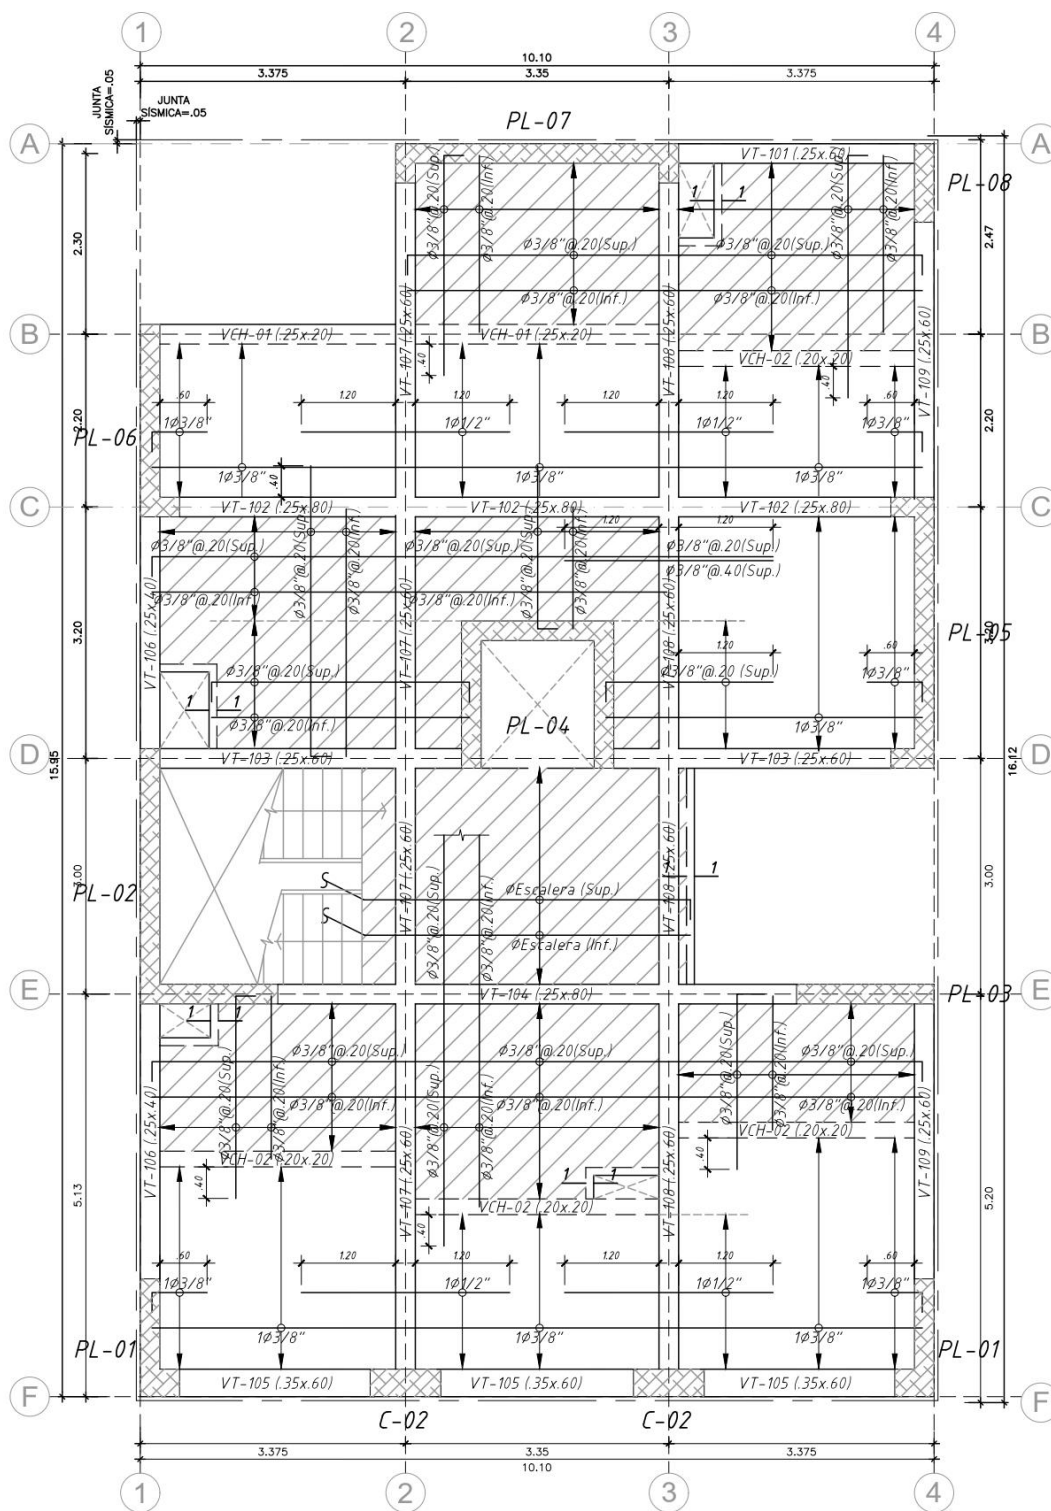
Armado de acero de losa aligerada y maciza. Fuente: Propia.
